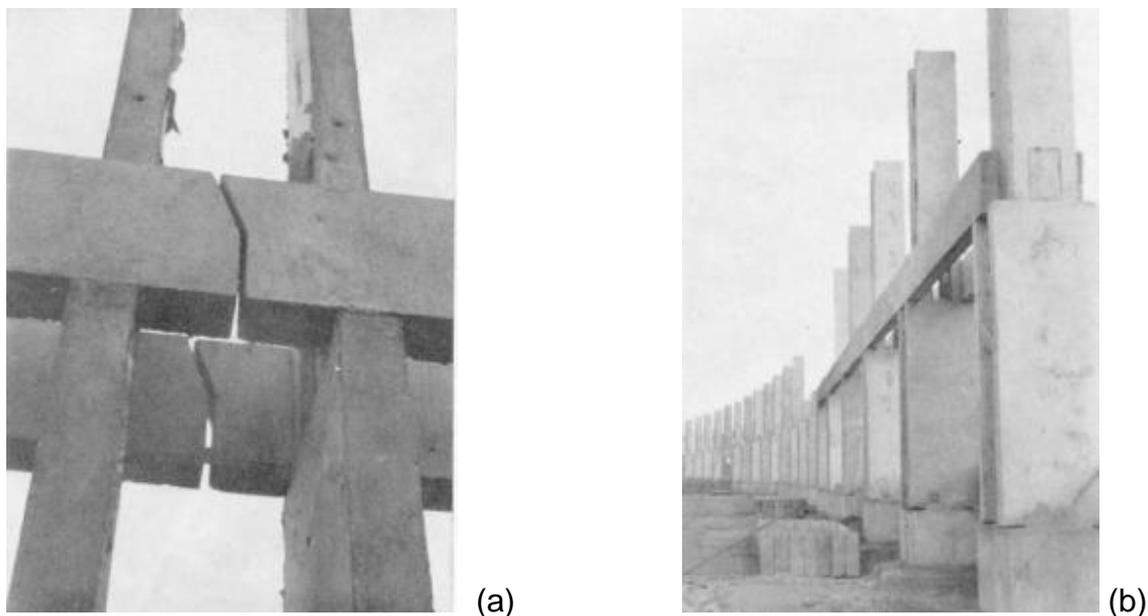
(a) e (b): Vigamento duplo e pilares de alma oca
